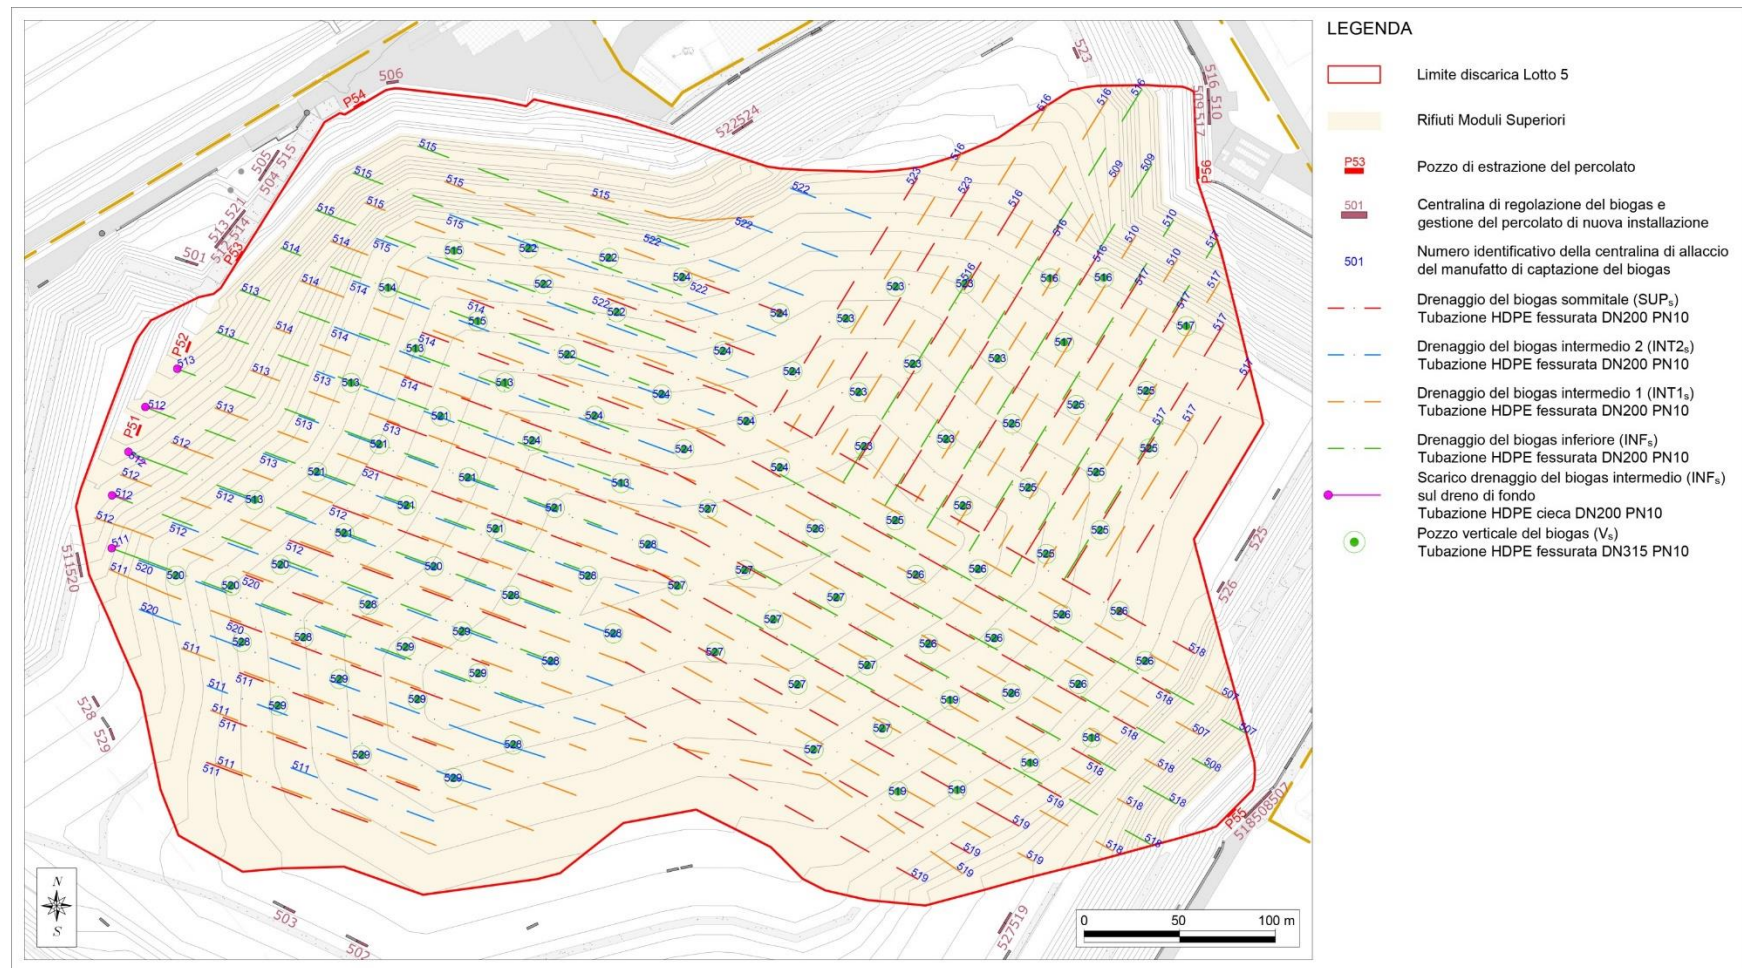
11 – Planimetria con disposizione dei manufatti di captazione del biogas dei moduli superiori
